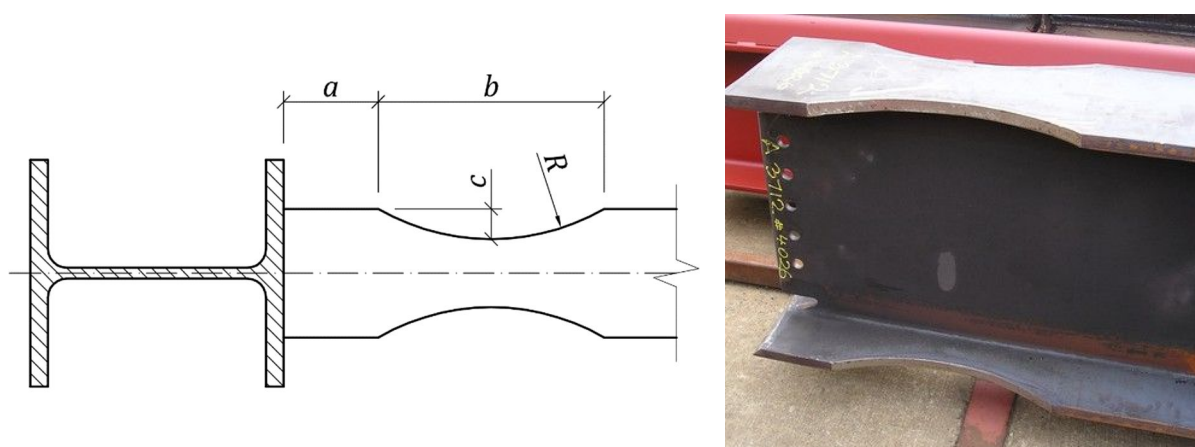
Úprava stojiny pro připojení pásnice [22]
